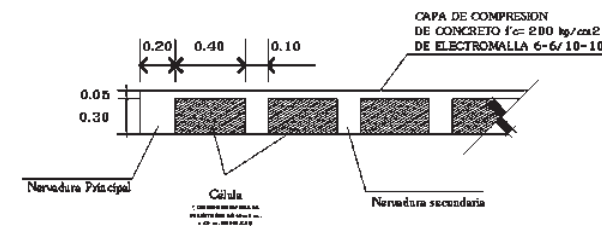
Detalle de losa aligerada. M. R. A. A.
